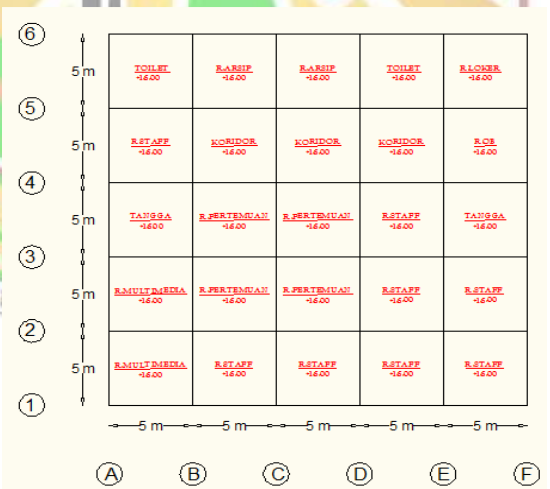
Layout Fungsi Ruang Lantai 1
